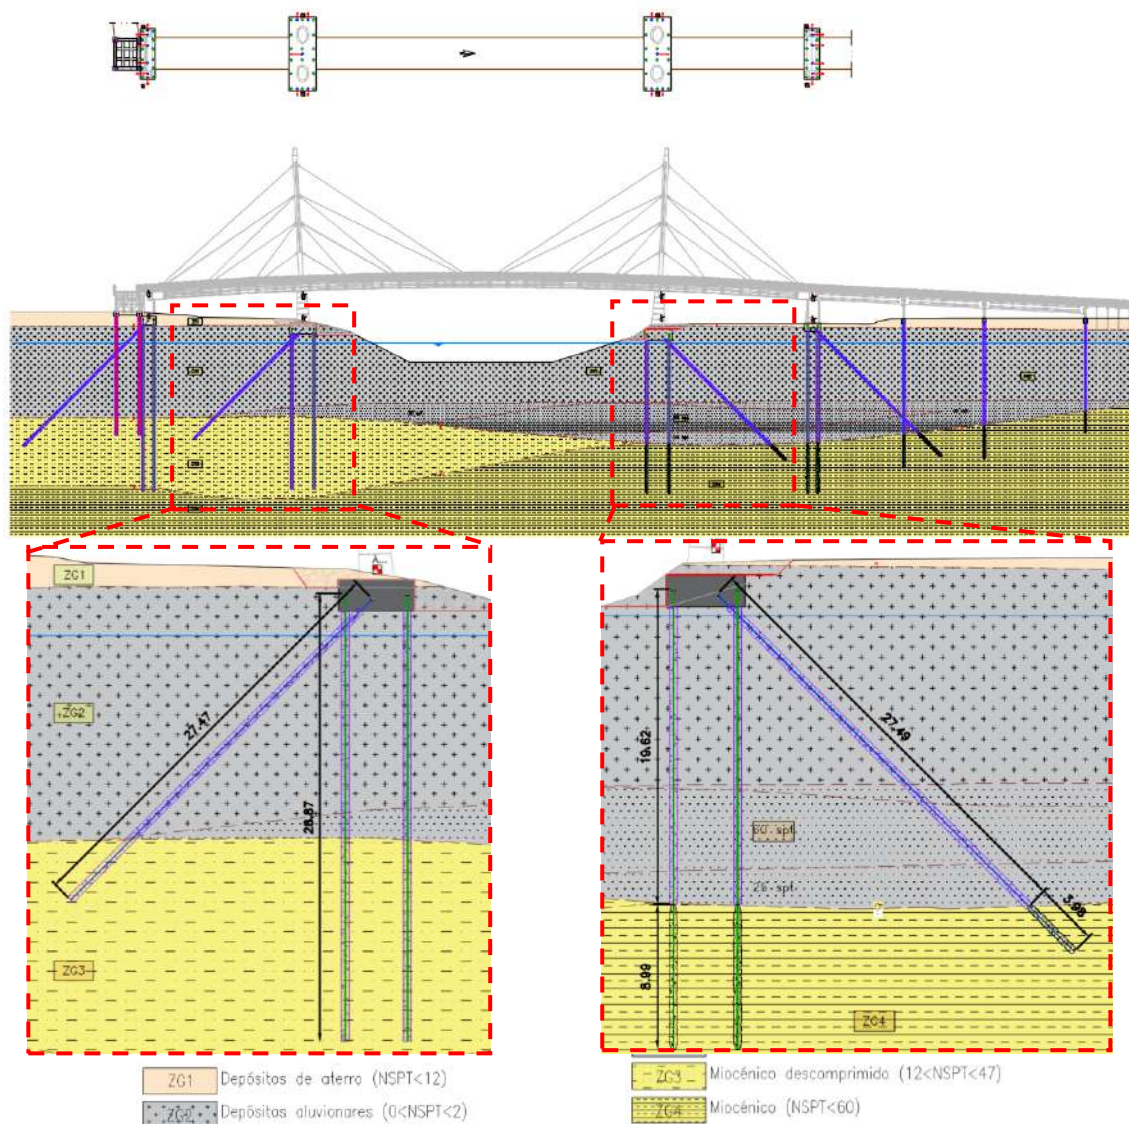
Planta e cortes longitudinais da solução de fundação com representação do perfil geológico e geotécnico local
